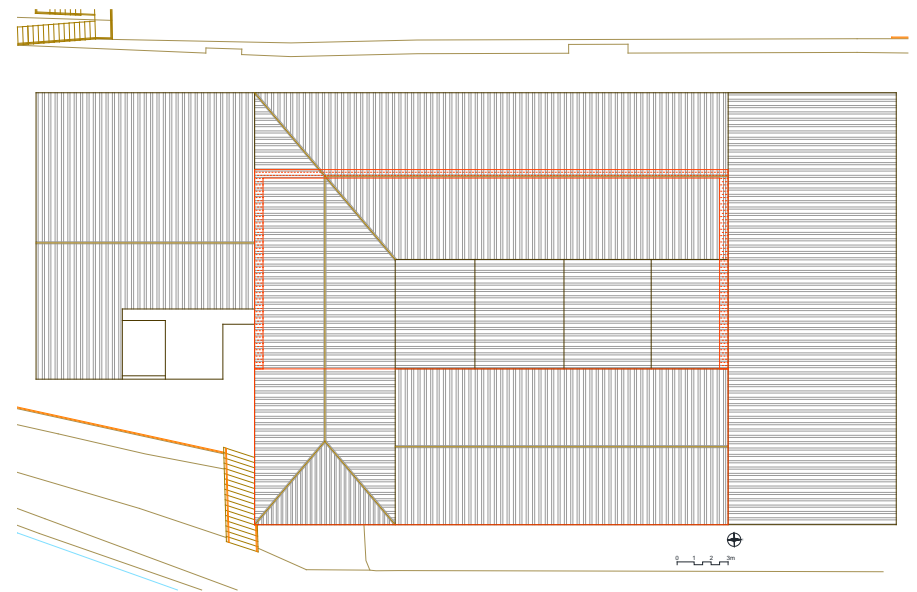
Plano de emplazamiento de la Casa de Labor original. Años 1907-1917.
